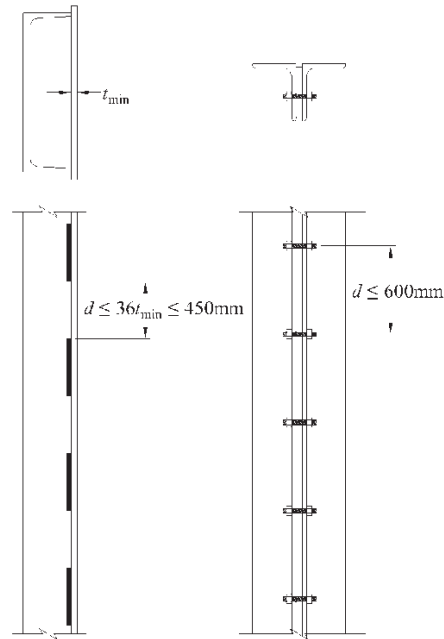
Separación máxima entre tornillos o soldaduras en miembros armados en tensión
